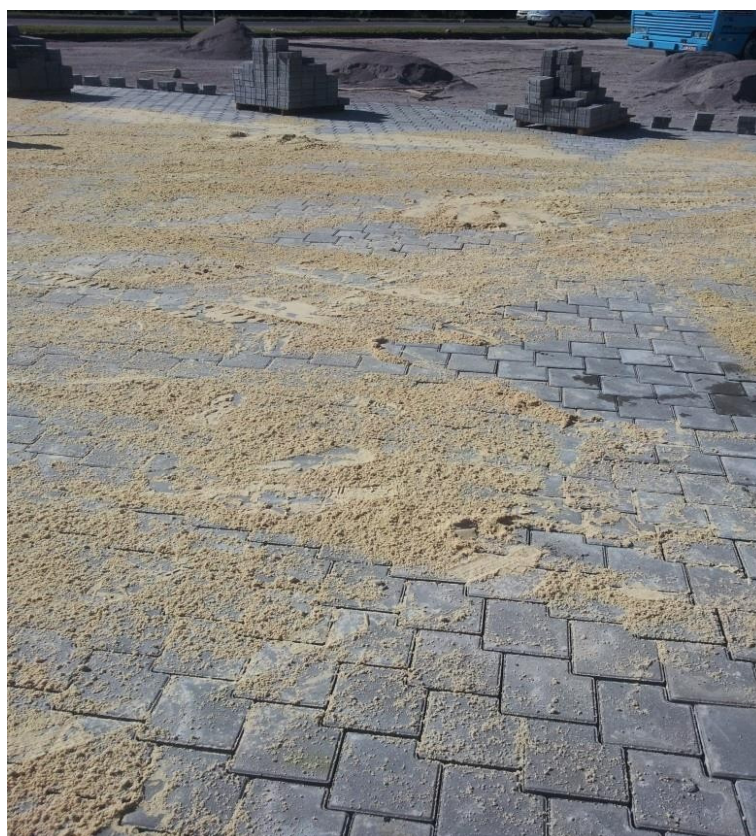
areia fina deve ser varrida para rejuntamento e preenchimento das juntas.
